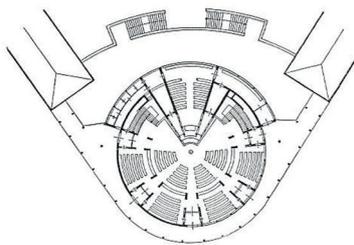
Auferstehungskirche in Essen Grundriss, 1930
